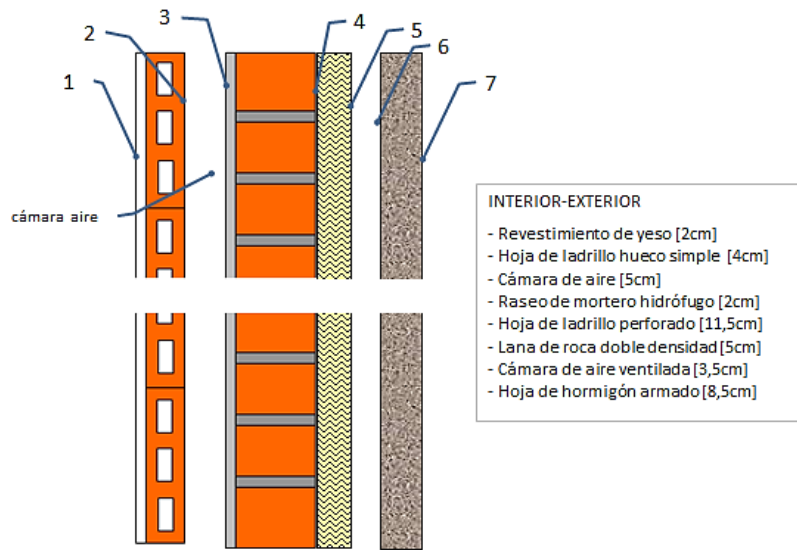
Solución constructiva de la fachada ventilada pesada
